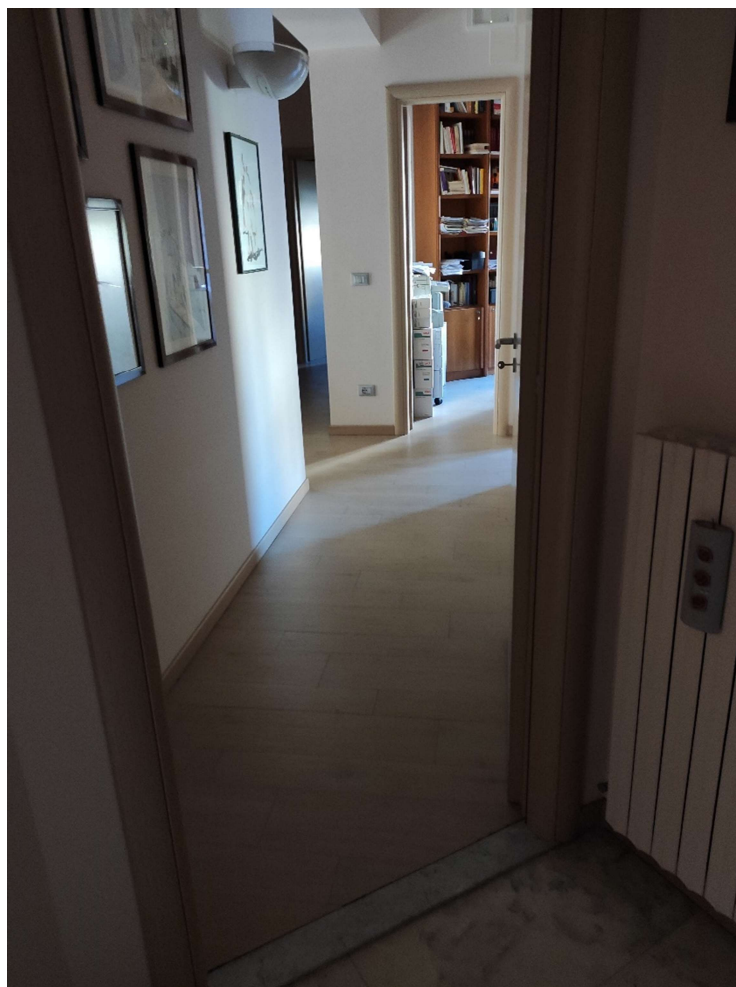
Zona studio aggiornata, rifatto pavimento. In fondo a dx la cucina modificata a camera da studio
